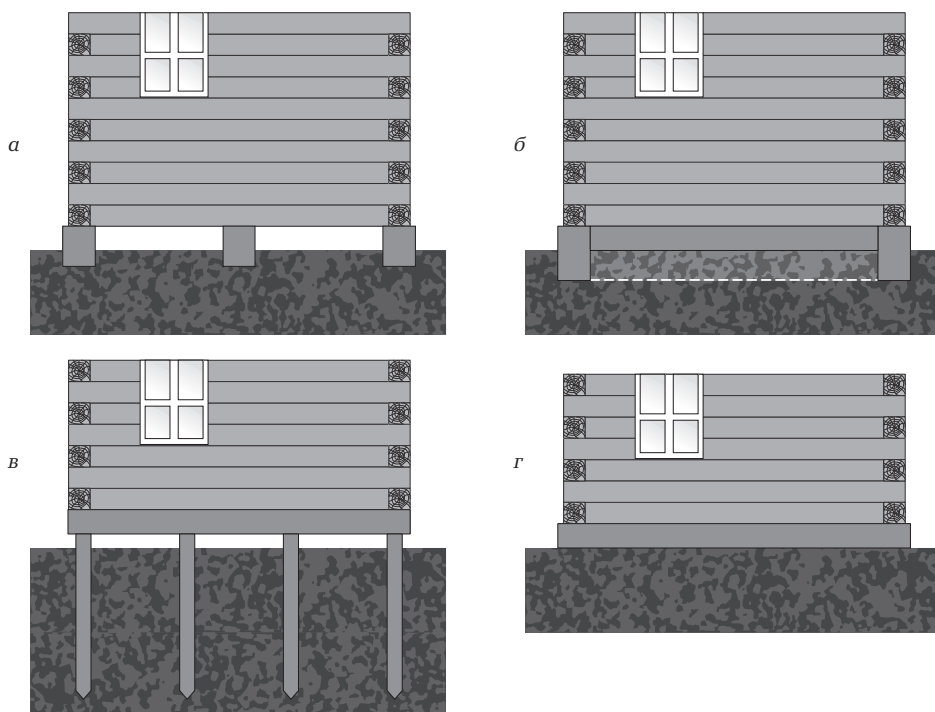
Типы фундаментов деревянного дома: а — столбчатый; б — ленточный; в — свайный; г — плитный (сплошной)
